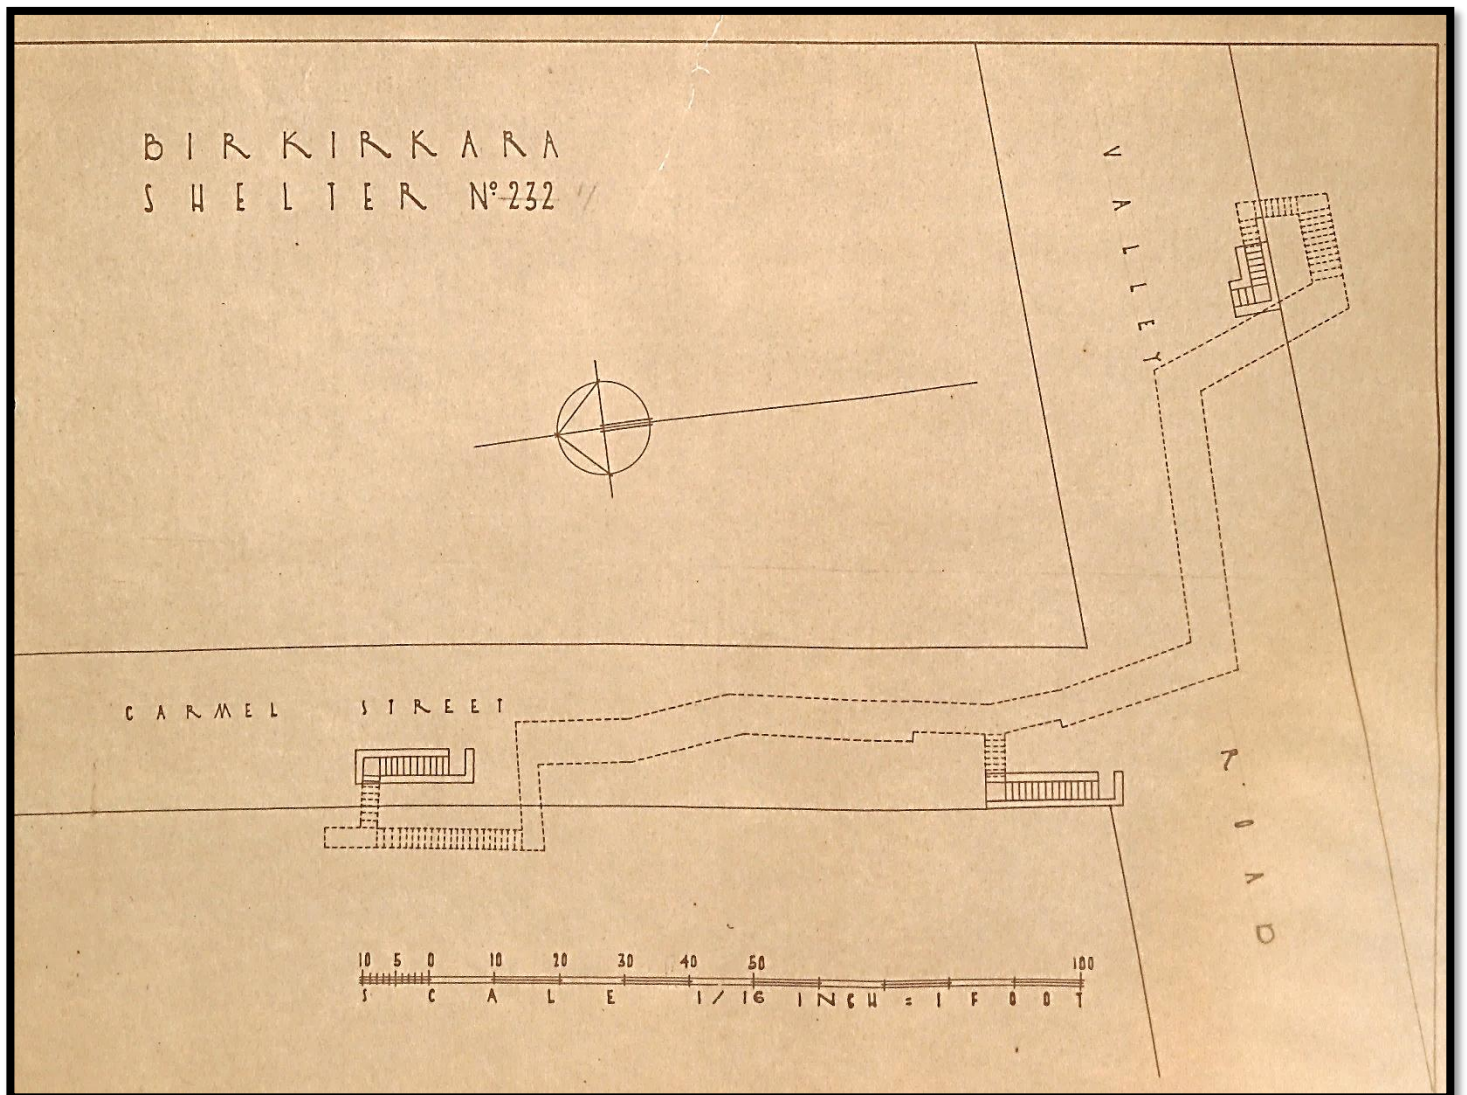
Planta do Abrigo nº232 (4) "Carmel Street – Valley Road"
